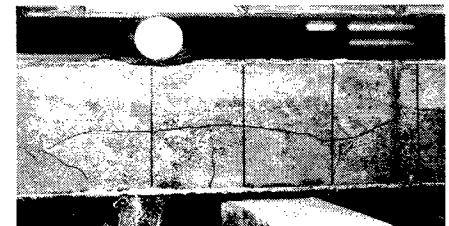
DFRCC 供試体(軸方向ひび割れ)
